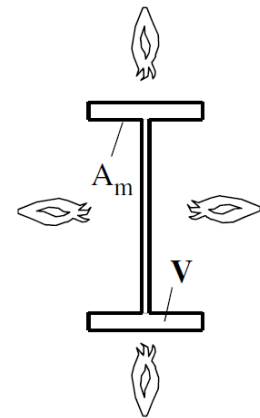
Sezione di un travetto. (Drawing: Rudy Van Impe)
